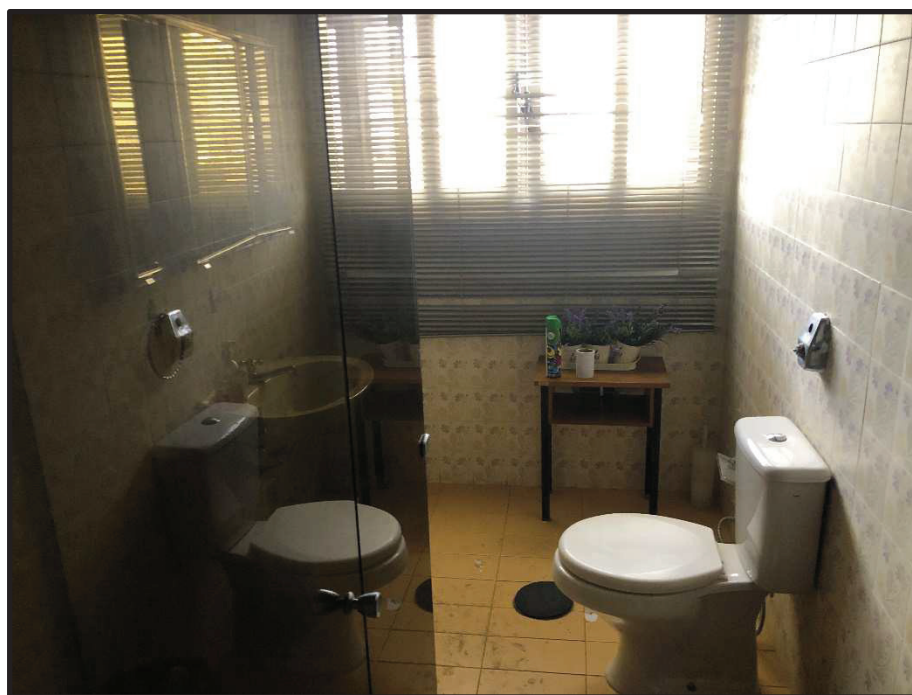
1º Pavimento – Banheiro dos escritórios
